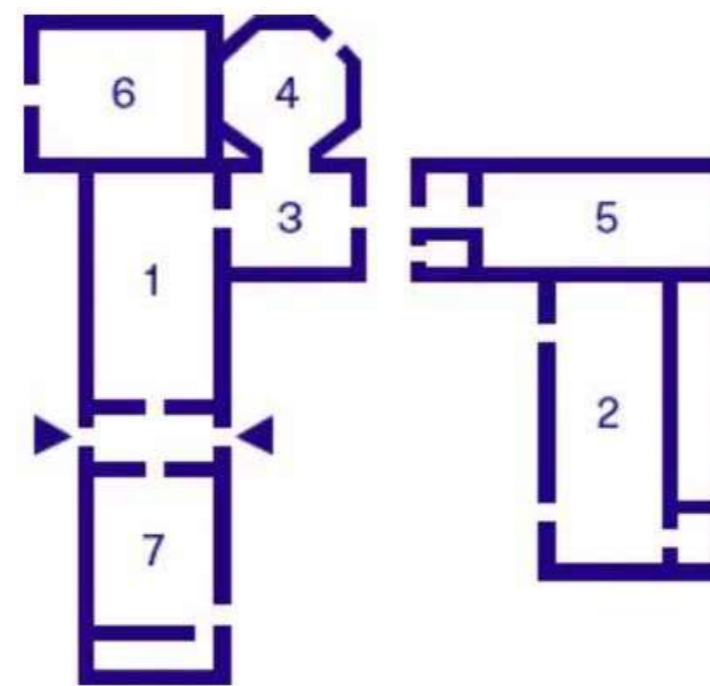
Österreich, Architektur Zentrum Wien, Grundriss, 1 Ausstellungshalle, 2 Ausstellungshalle, 3 Galerie, 4 Bibliothek / Sammlung, 5 Podium, 6 Werkstatt, 7 Cafe-Restaurant
